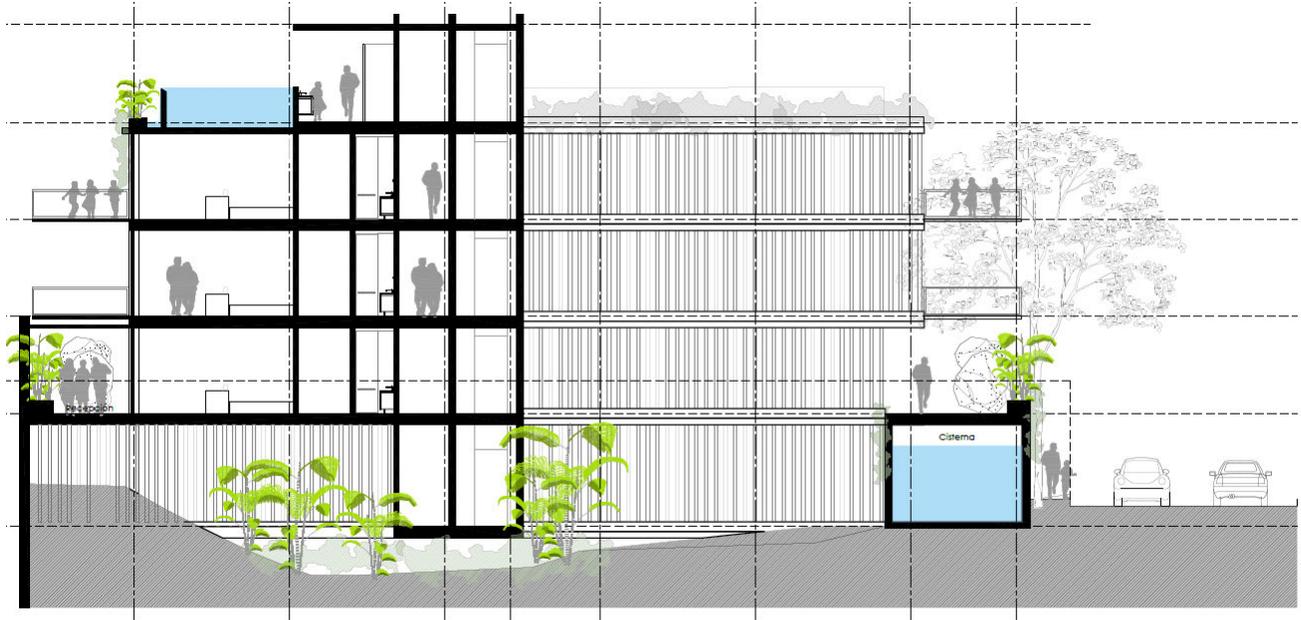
Plano Fachada Principal. Fuente: Plano Arquitectónico.
